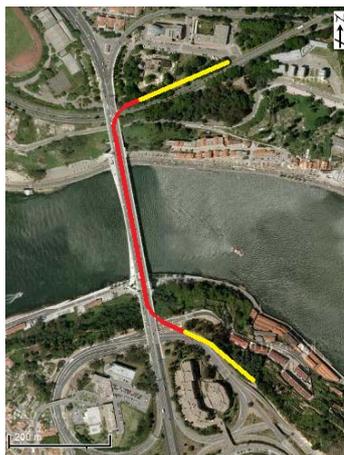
Traçado sugerido para a nova estrutura (vermelho) e acessos (amarelo)
